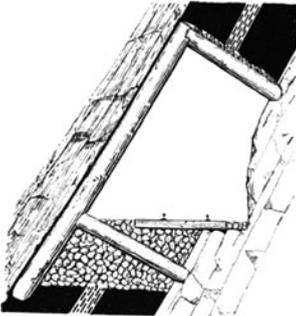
Schalholzzimmerung mit untergeschlagenem Bahnstempel.
